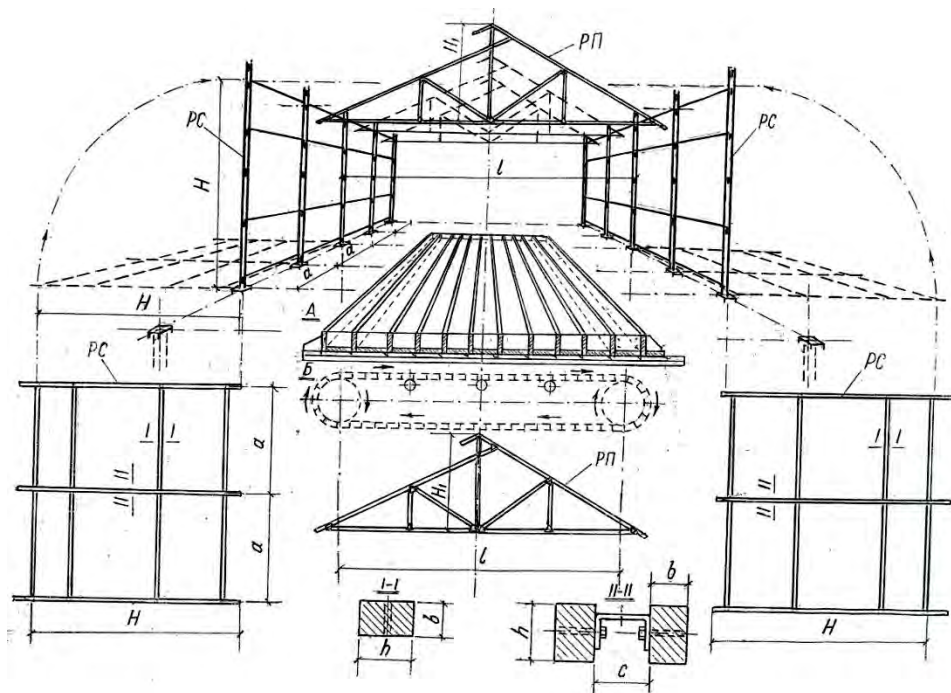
Схеми до технології монтажу каркасної системи одноповерхового будинку і виготовлення однотипних збірних елементів: РС – рами стін; РП – ригель рами – покриття і перекриття у вигляді трикутної ферми; А – збірно-розбірні форми для стендового виготовлення збірних елементів; Б – схема пластинчатого конвеєра для автоматизованої технологічної лінії з виготовленням збірних елементів
